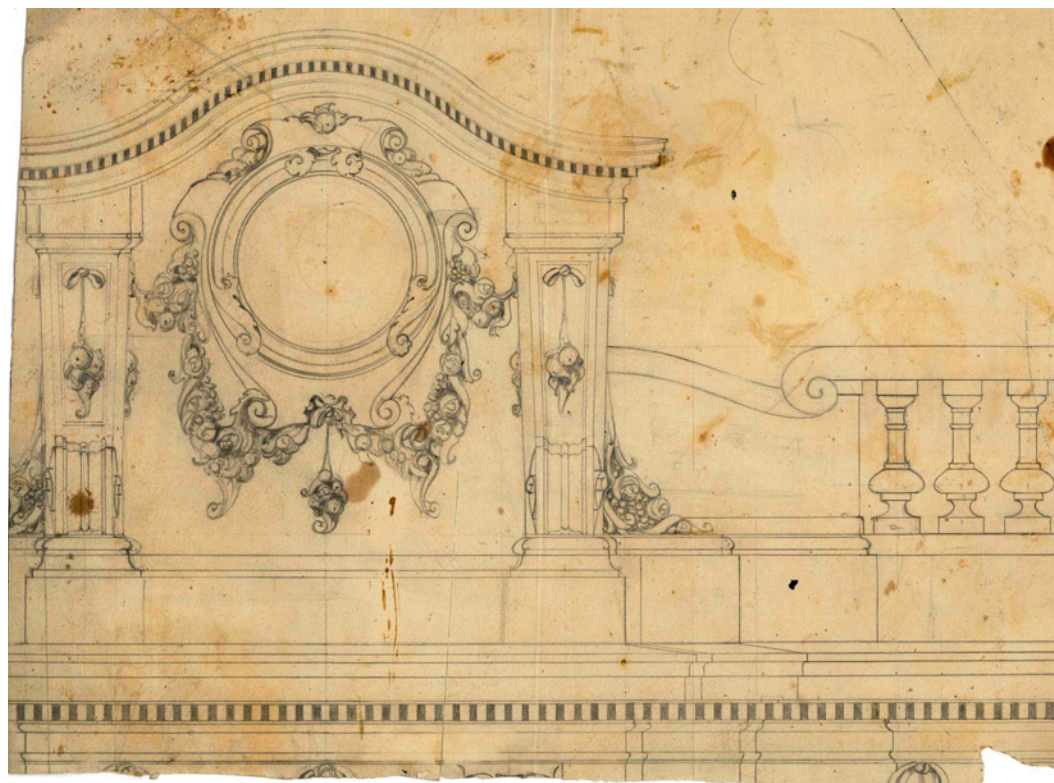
Detalle de la fachada principal de la Casa Serrat. Archivo Lorenzo Ros.
